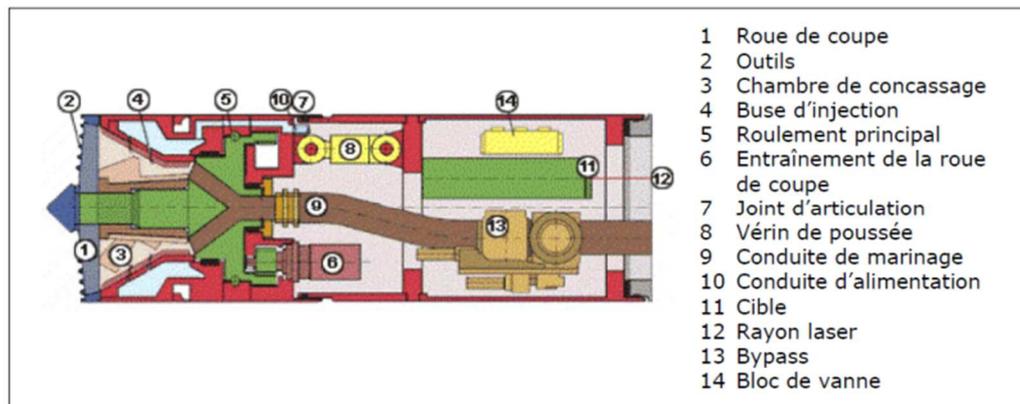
Plan en vue transversale d'une tête de coupe d'un micro-tunnelier à marinage hydraulique AVN 250-700 Herrenknecht (rapport de stage INSA M. Soler, 2007).
